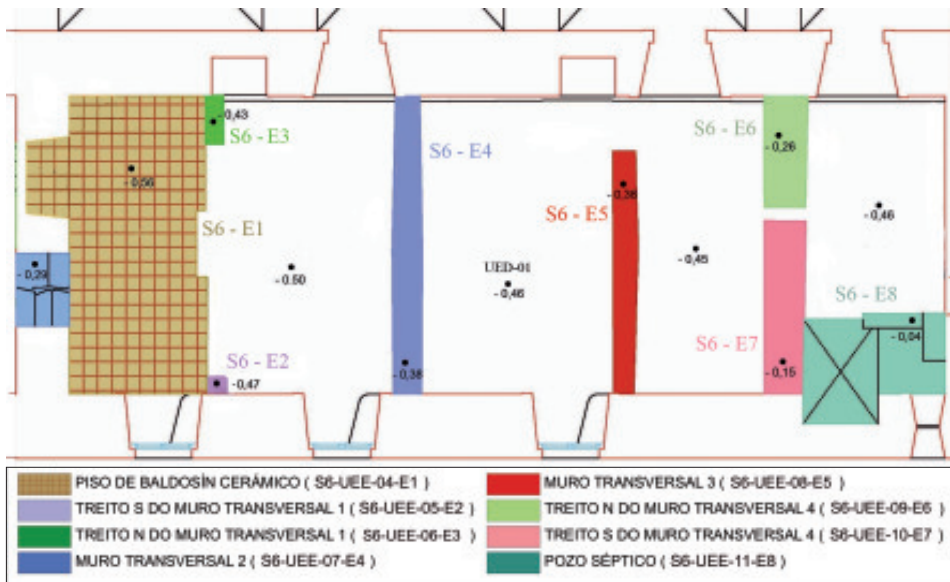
Croquis xeral da planta da sala 6, con indicación das estruturas exhumadas.
